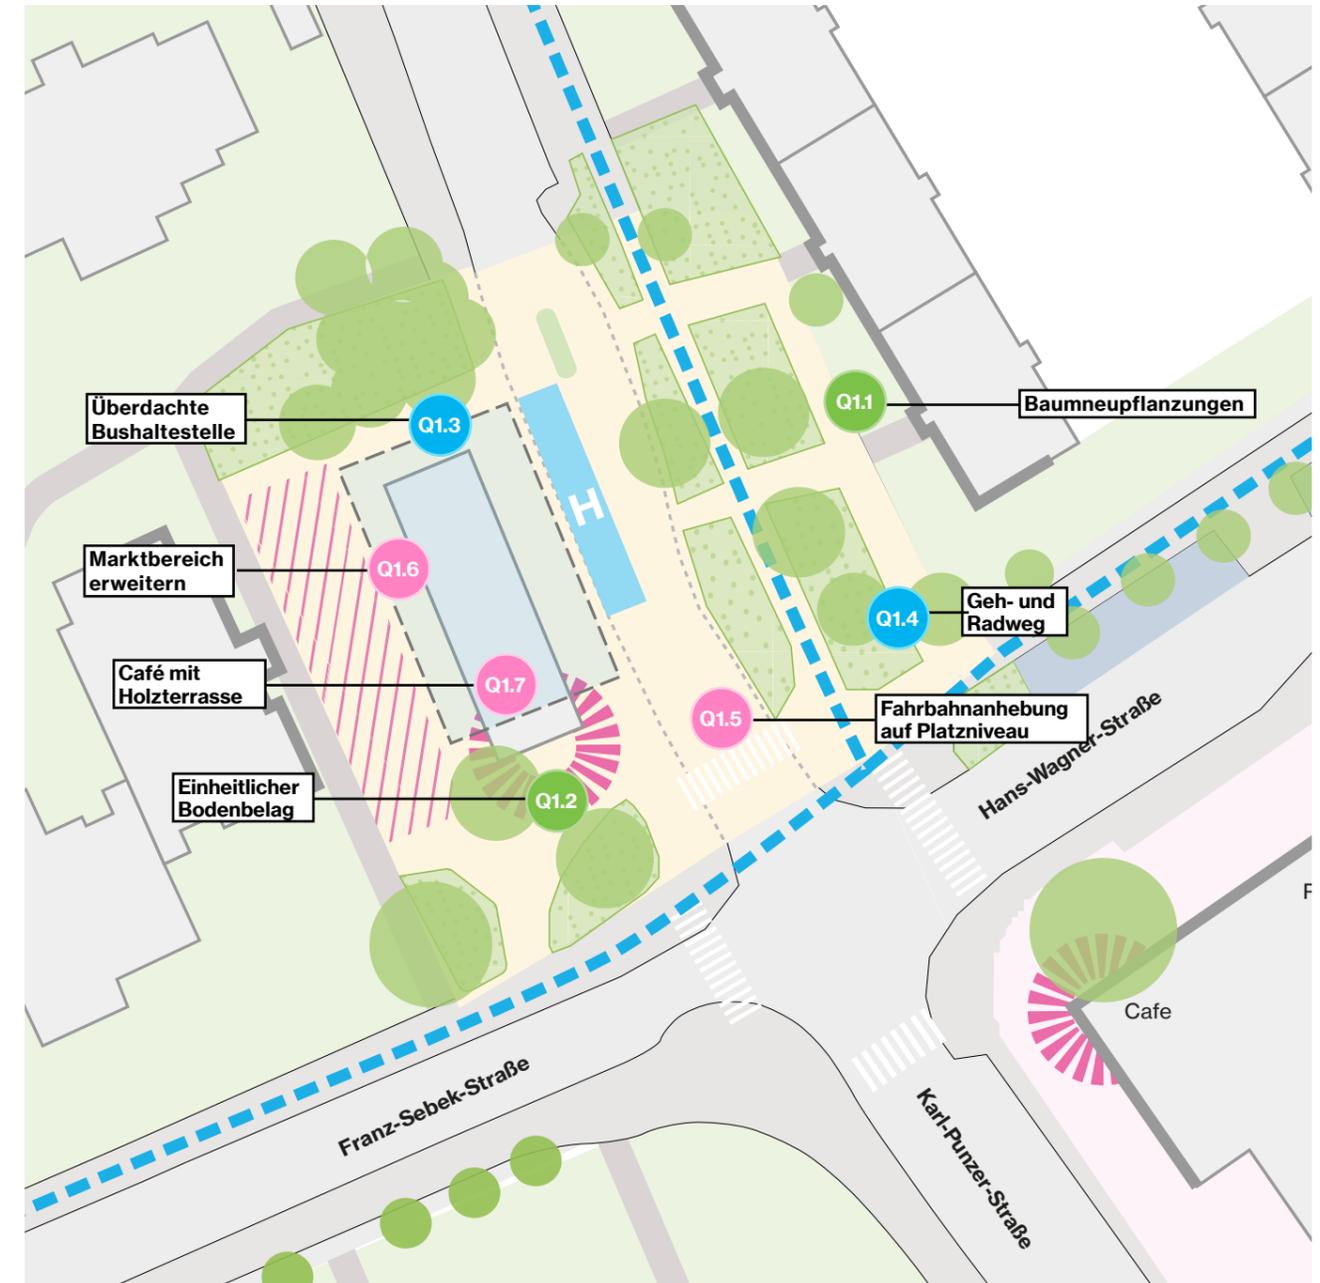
Detailplan Prototyp Marktplatz, Darstellung: Modul5
